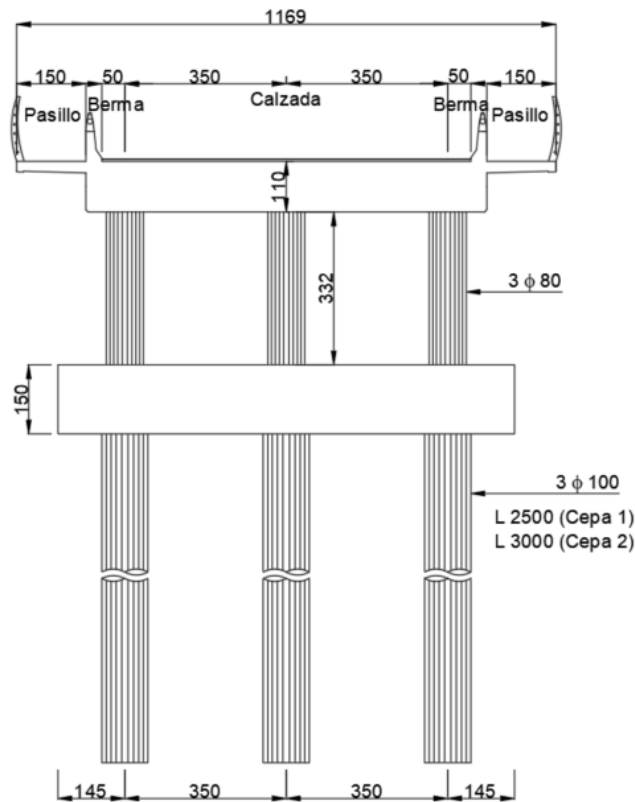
Cepas Puente 486-ES Laraquete (dimensiones en cm).
